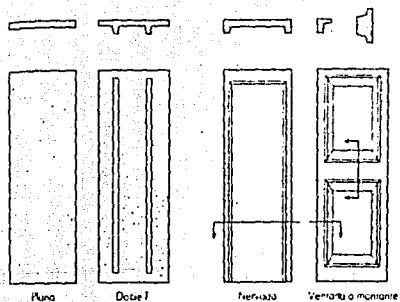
PANELES DE MURO EN CONCRETO PREFABRICADO.
